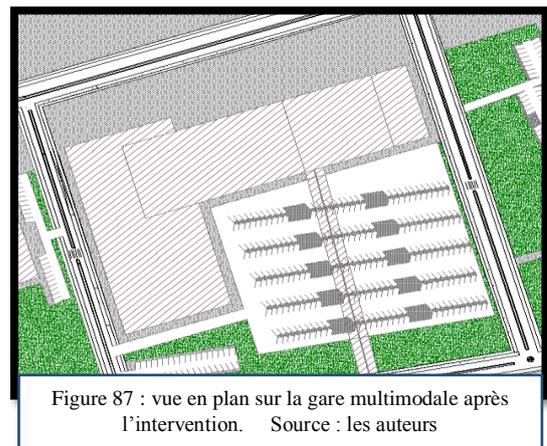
vue en plan sur la gare multimodale après l'intervention. Source : les auteurs
